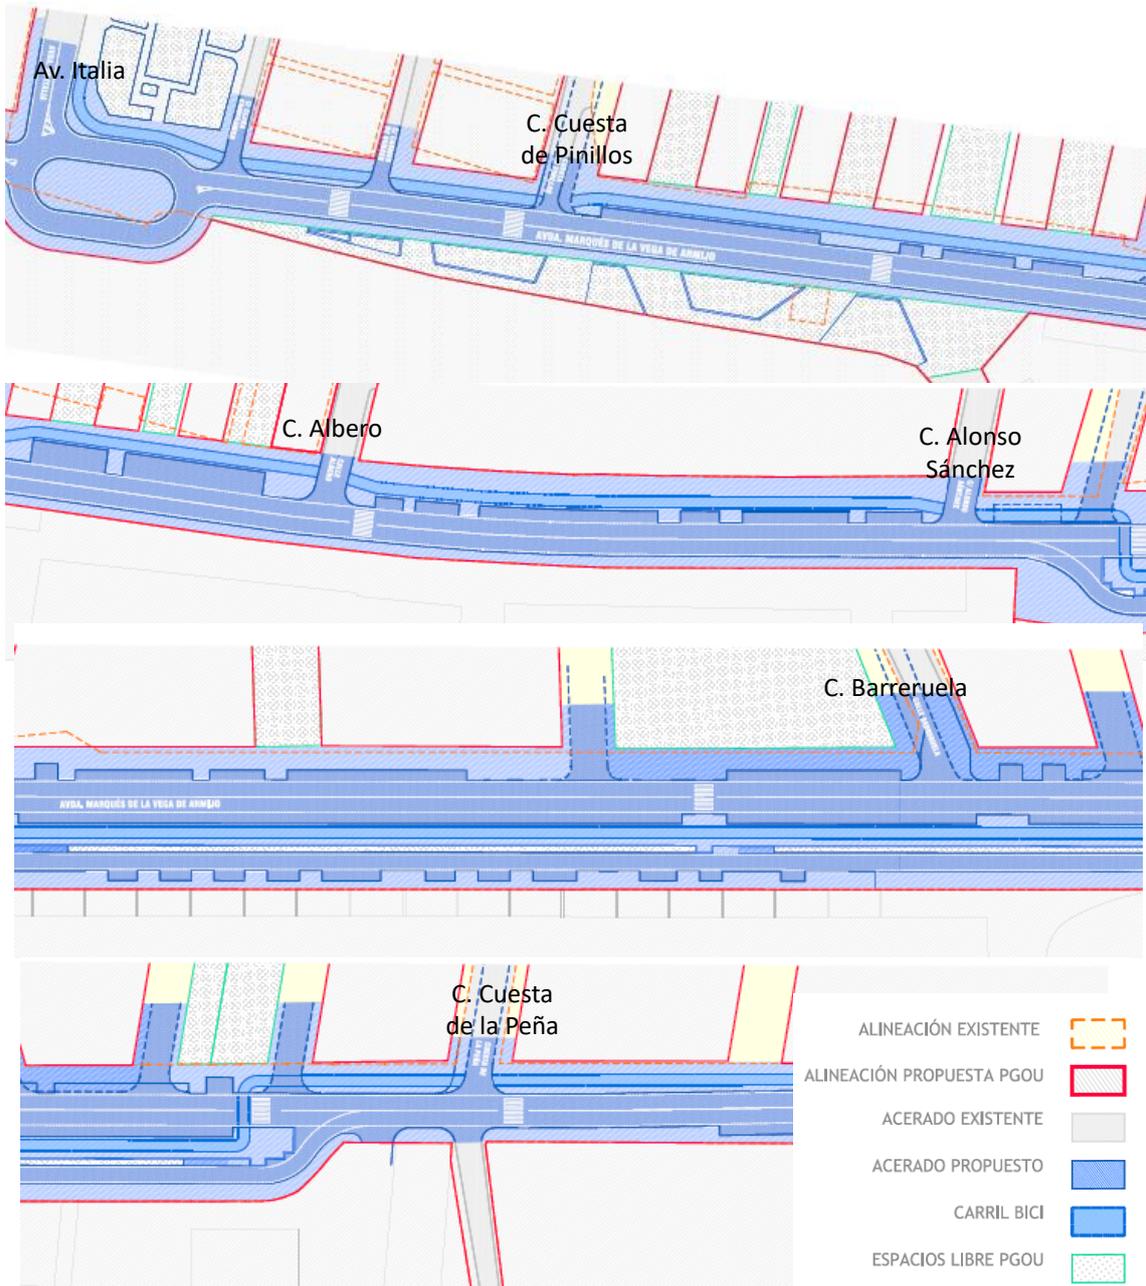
Propuestas de reordenación de la vía en Av. Marqués de la Vega Armijo en planta
